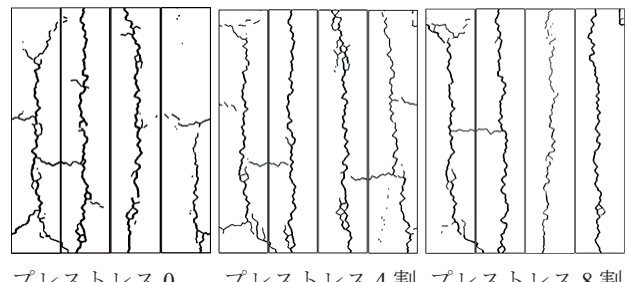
鋼材腐食時の表面ひび割れ展開図
